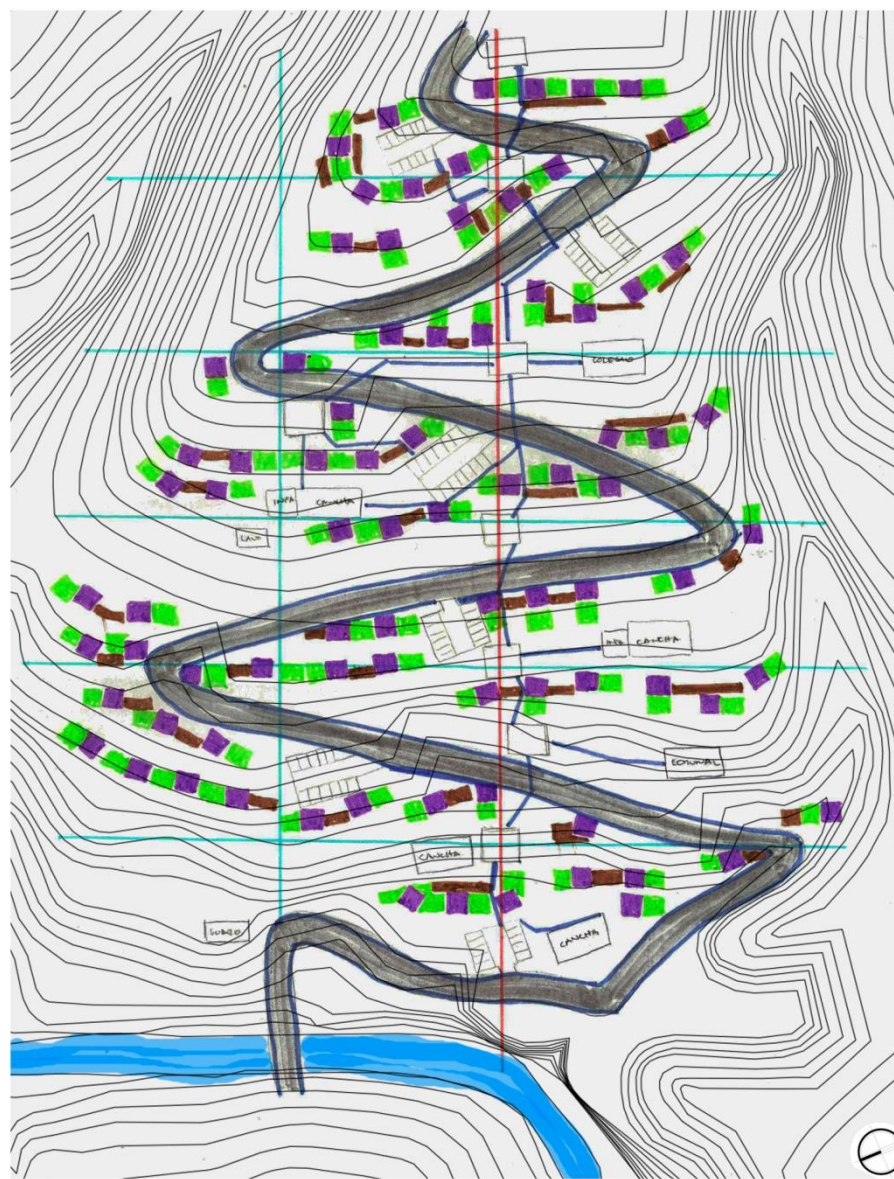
2da. Propuestas de equipamiento y caminerías peatonales
